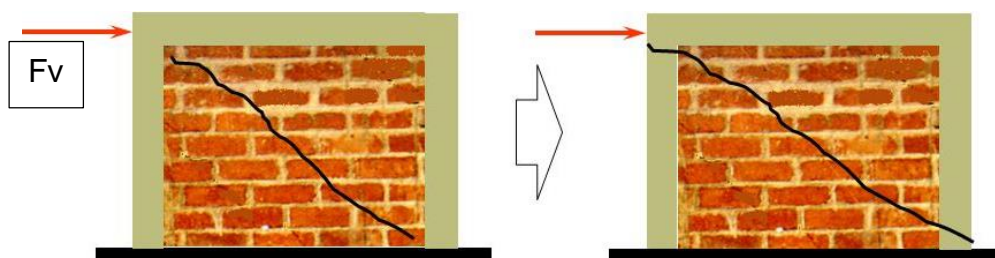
Falla por corte (Fuente: Albañilería Confinada- Sesión 2)
